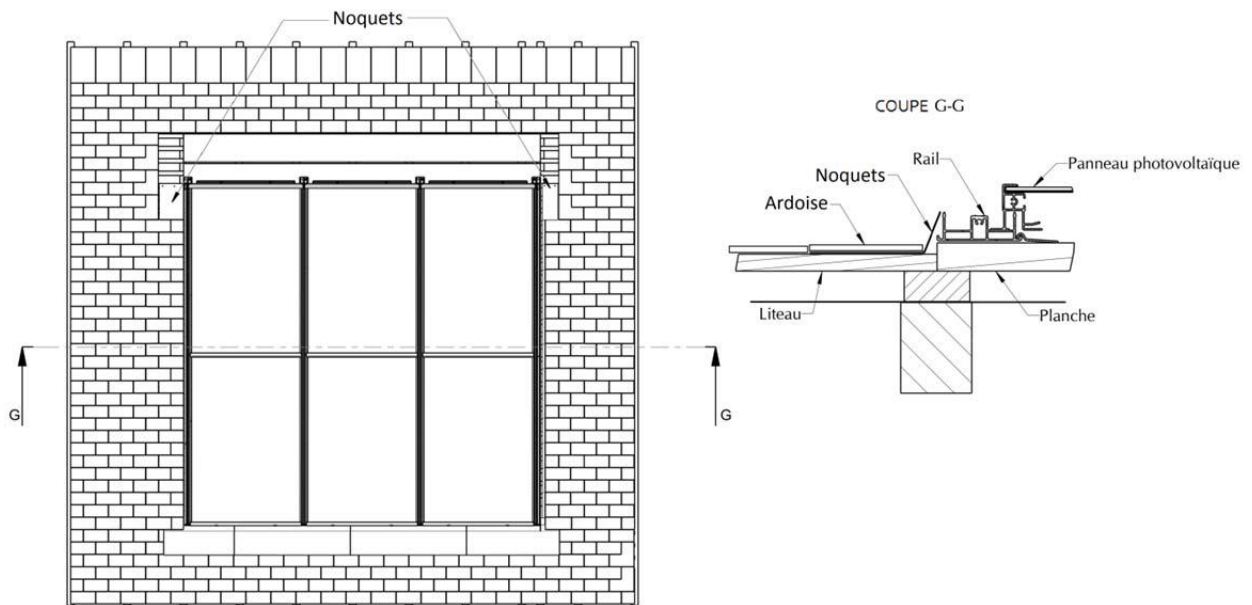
Pose des abergements latéraux droit et gauche pour installation sur toiture ardoise
